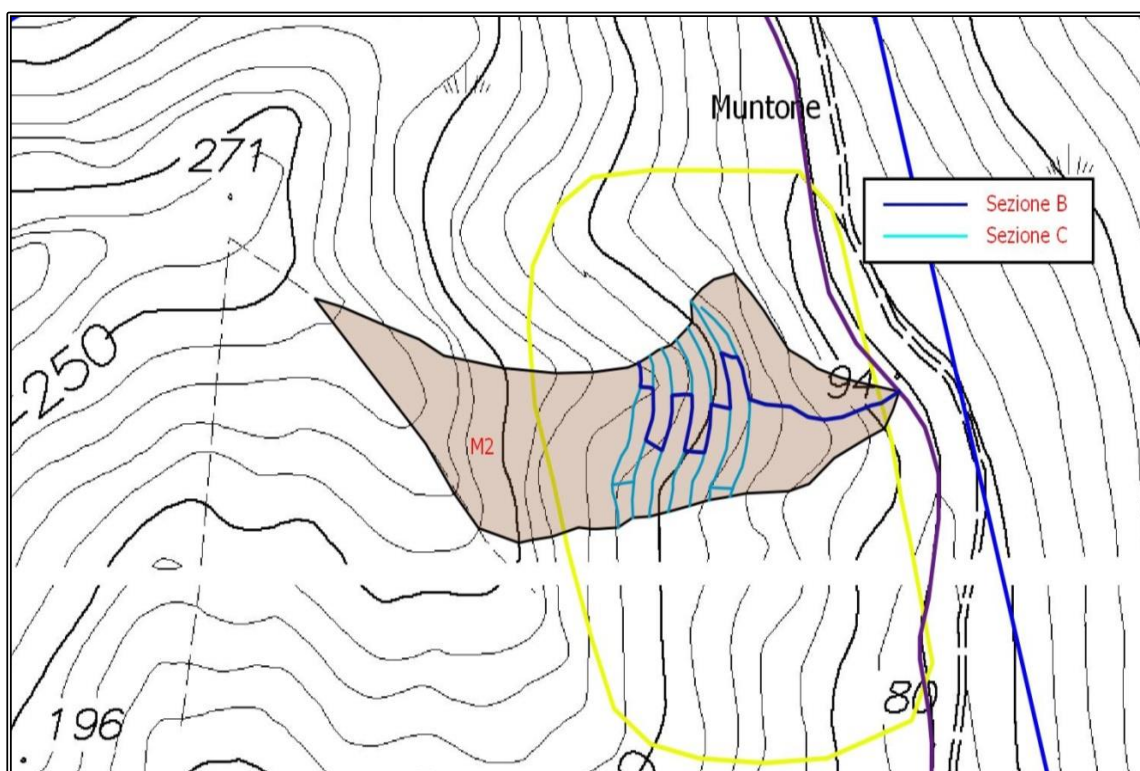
Schema della rete di drenaggio, con tipologia di sezione trasversale di progetto (Cantiere di Muntone M2).
